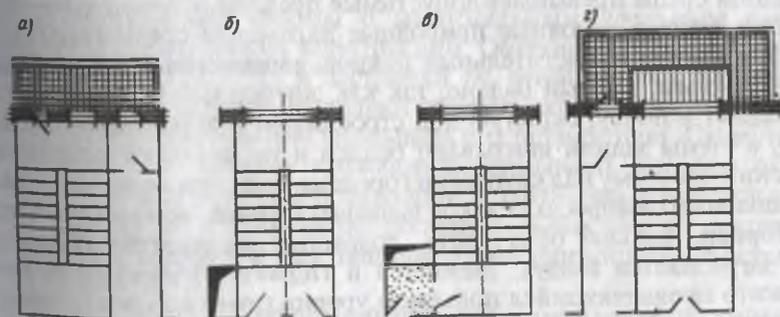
Эвакуационные пути в зданиях высотой более 10 этажей:
